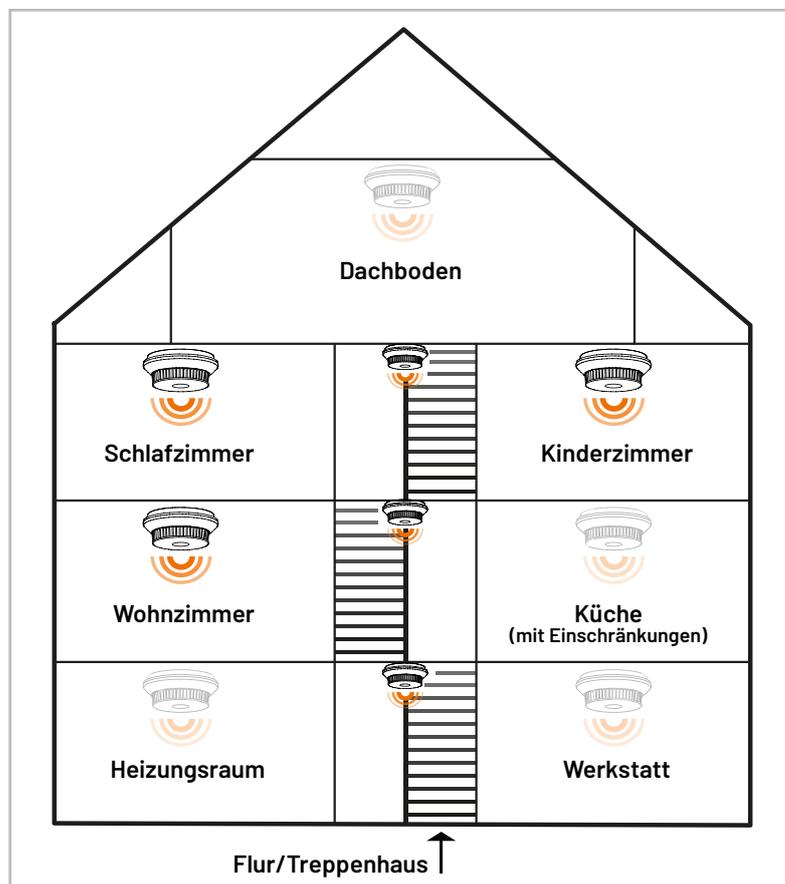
Mindestausstattung mit Rauchmeldern in einem typischen Einfamilienhaus - Ausstattung in Küche, Heizungsraum und Werkstatt mit Einschränkungen aufgrund erhöhter Gefahr von Falschalarmen
